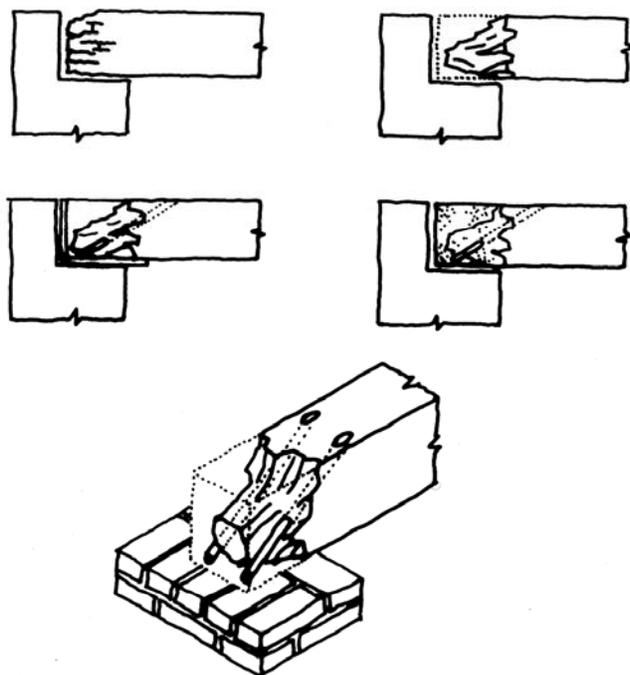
Reconstrucción parcial de la cabeza de la viga.
